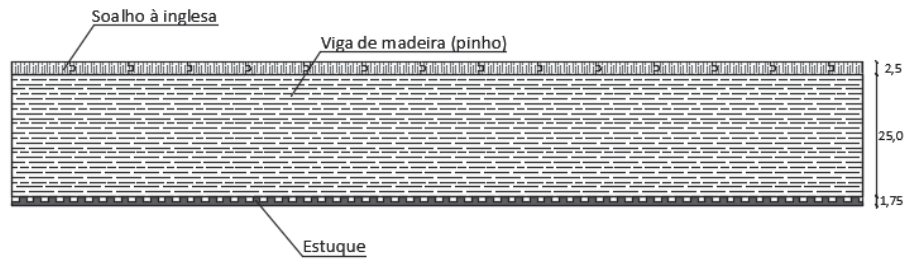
Pavimento piso 1: Corte longitudinal (cm)
